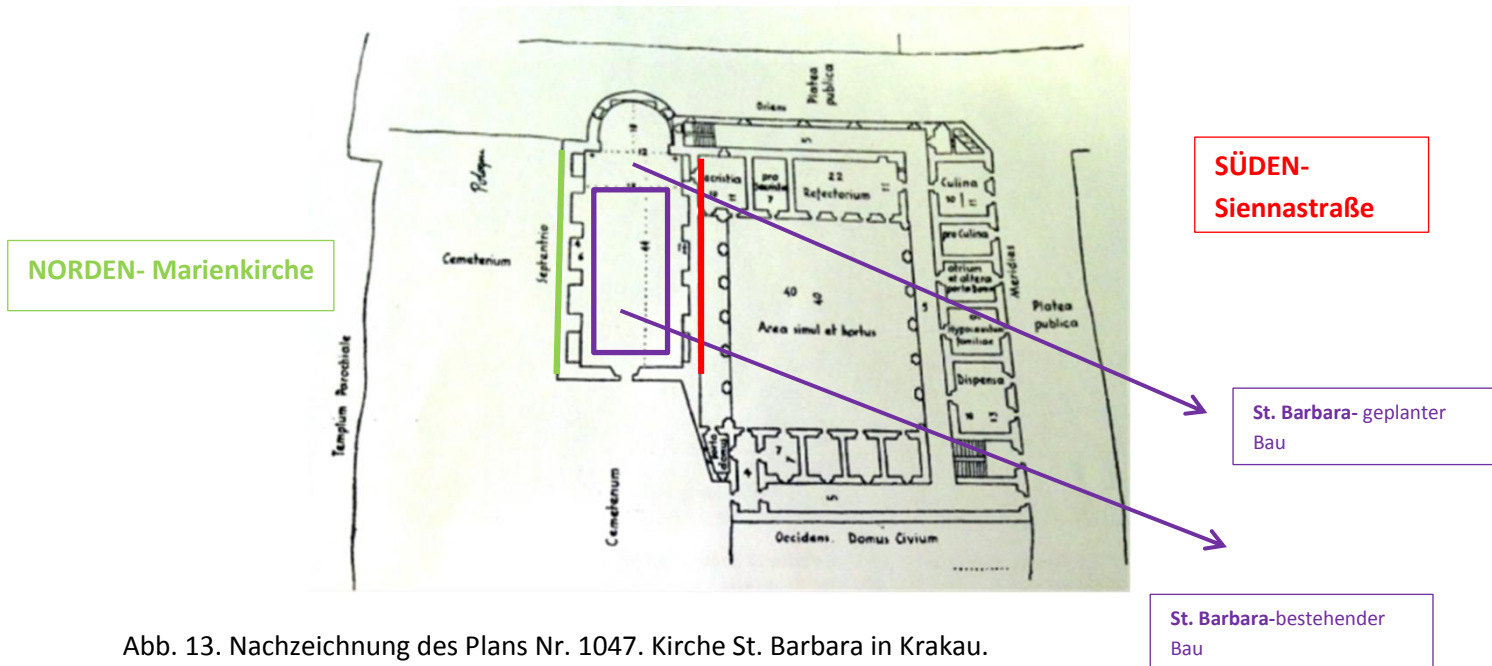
Nachzeichnung des Plans Nr. 1047. Kirche St. Barbara in Krakau.
